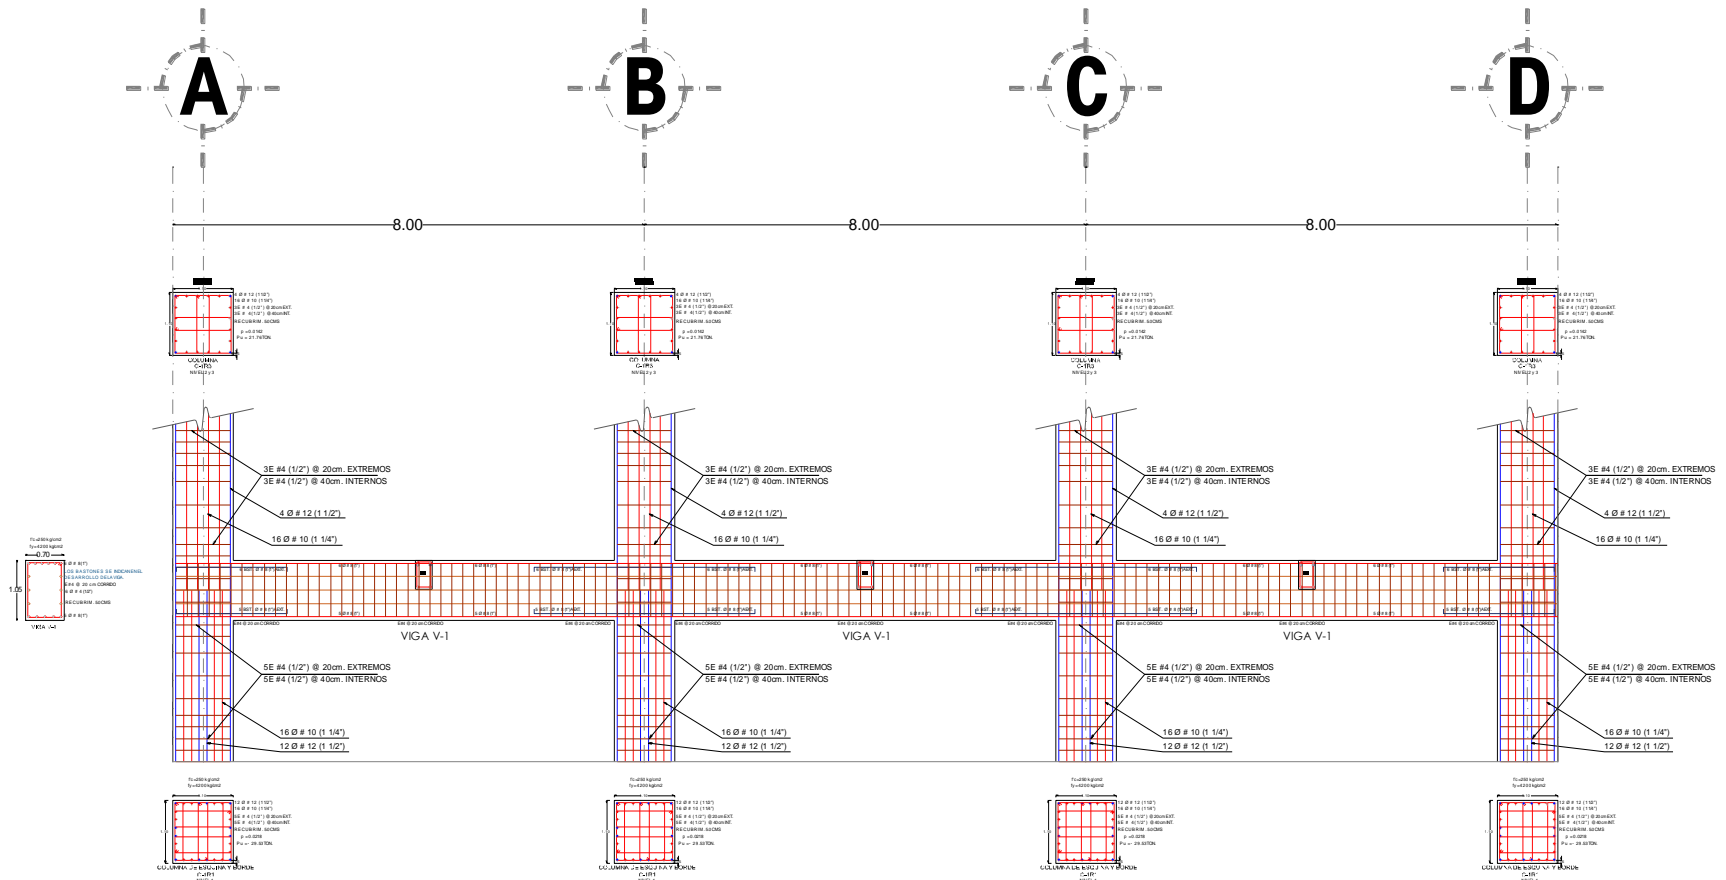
Alzado de armado de columnas y vigas de edificio de 9 niveles con base a la hipótesis de las NTCC-17.
